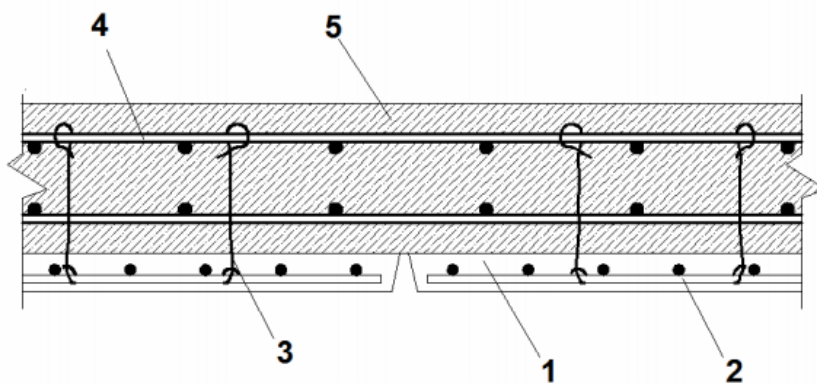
1 – листы армированного пенополистиролбетона, 2 – арматурная сетка листов, 3 – выпуски вязальной проволоки из листов, 4 – арматура балок или плит монолитного перекрытия, 5 – скрепляющий слой монолитного бетона
